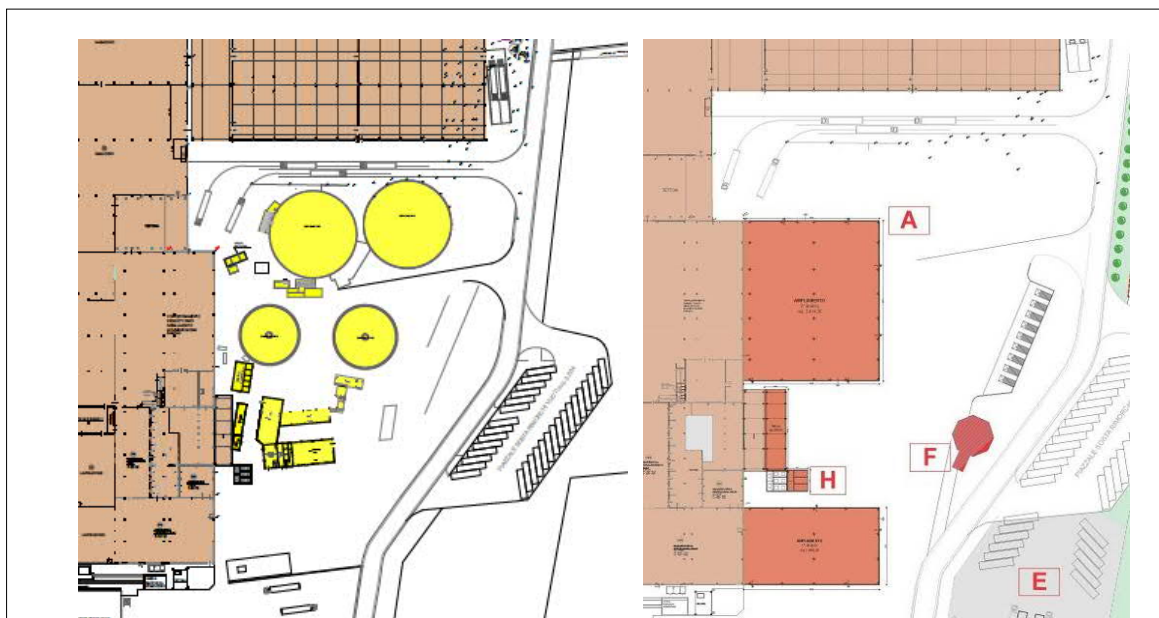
Estratto delle Tav. 02-03 Planimetria generale delle demolizioni (a sx) e nuovi interventi (a dx)
